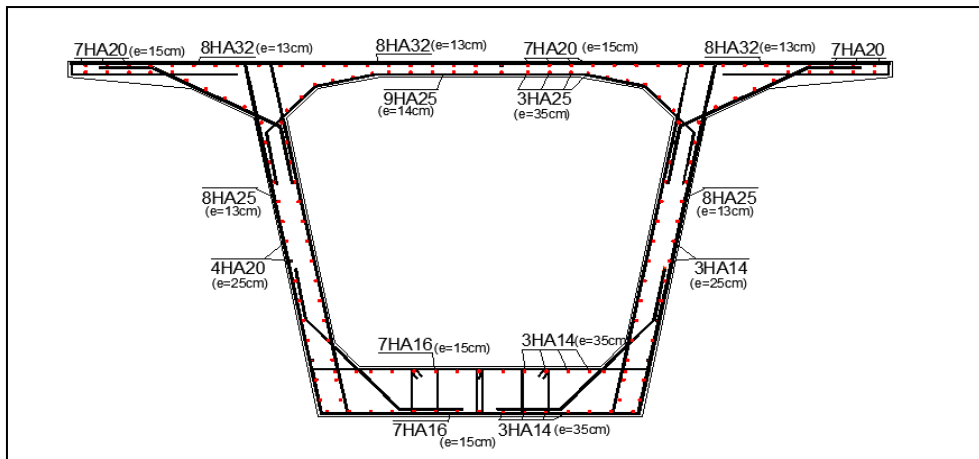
Schéma de Ferrailage du voussoir sur pile.
